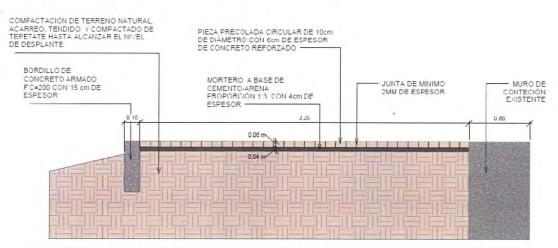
Vista en alzado de sistema constructivo para la plaza de acceso Rosario Castellanos.
